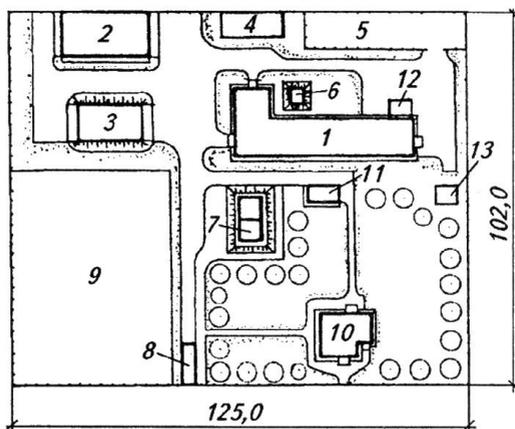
Генеральный план фермы по производству молока на 50 коров:
